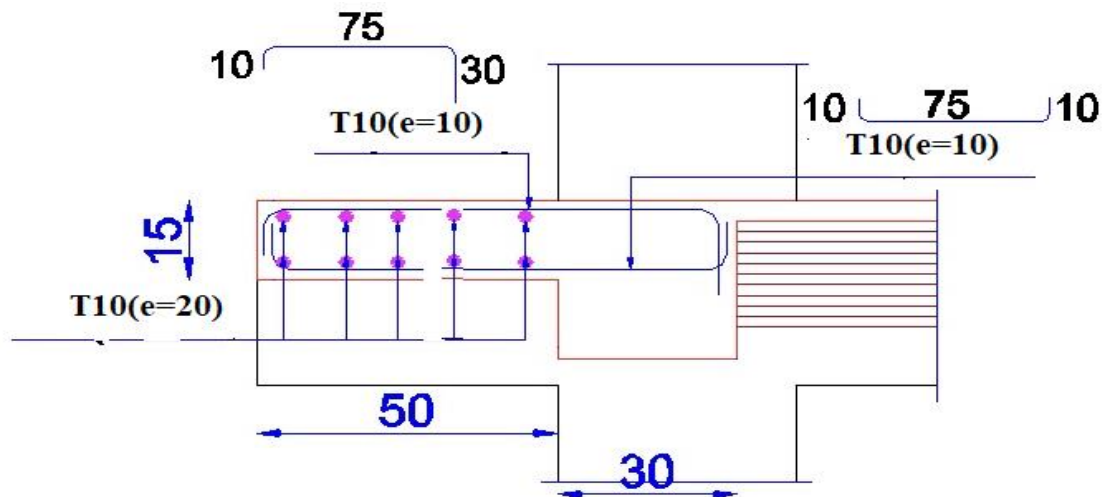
Schéma de ferrailage de dalle balcon Dp2.
